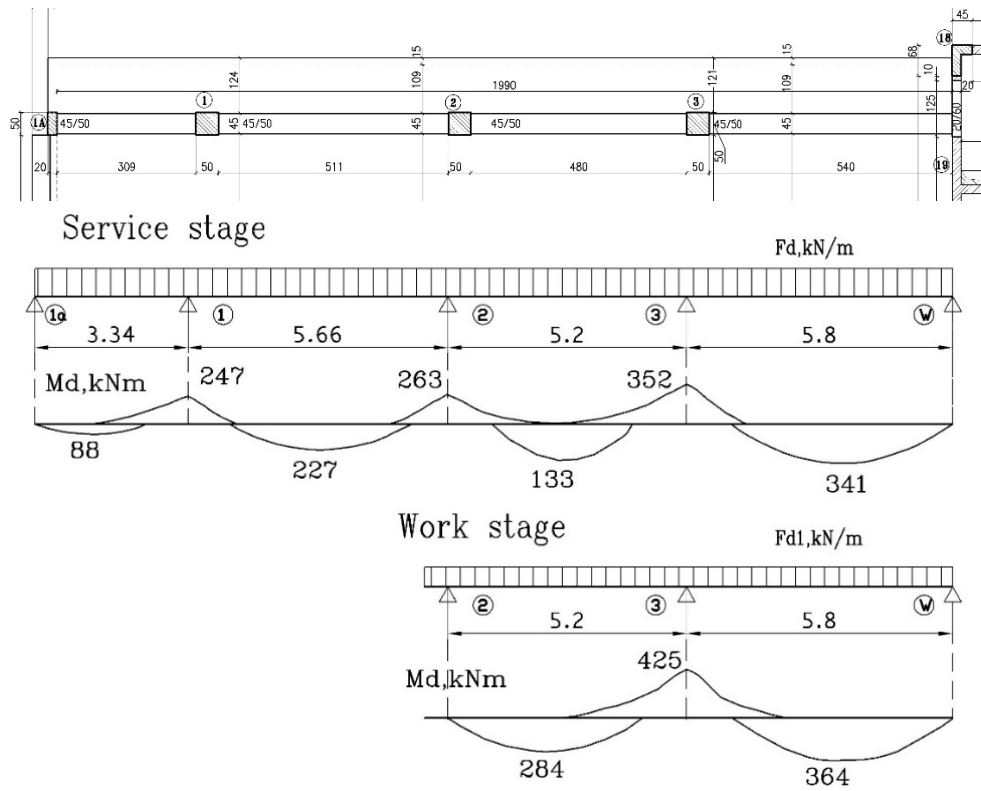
Фрагмент плана типового перекрытия, статические схемы и эпюры моментов в балке в стадии эксплуатации и при производстве работ
